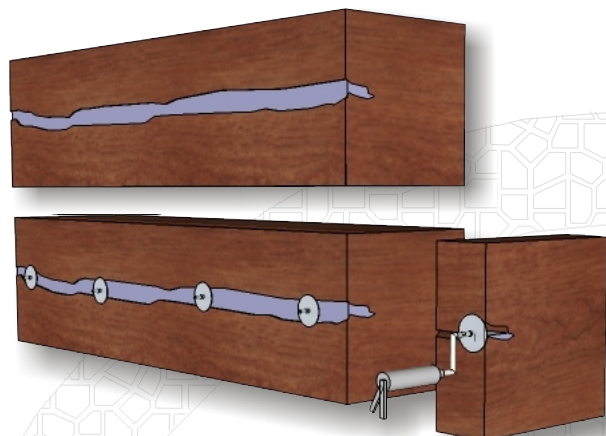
Preenchimento com resina epóxi de área com rachadura em peças estruturais do telhado.
